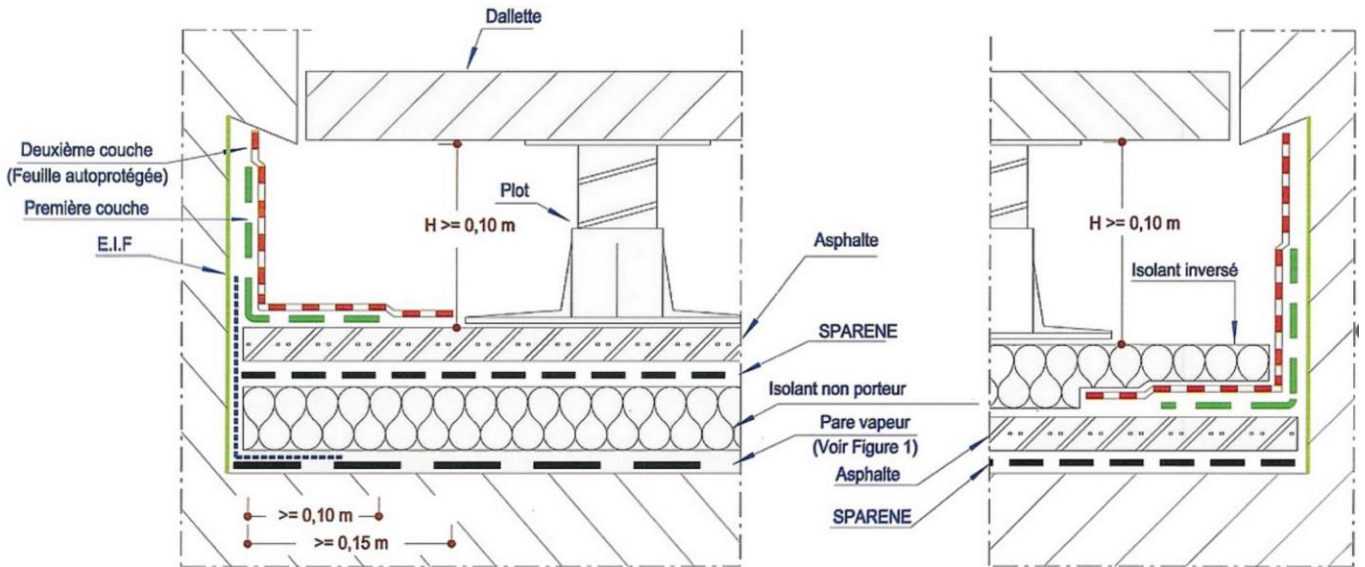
Terrasses accessibles aux piétons. Protection par dalles sur plots
